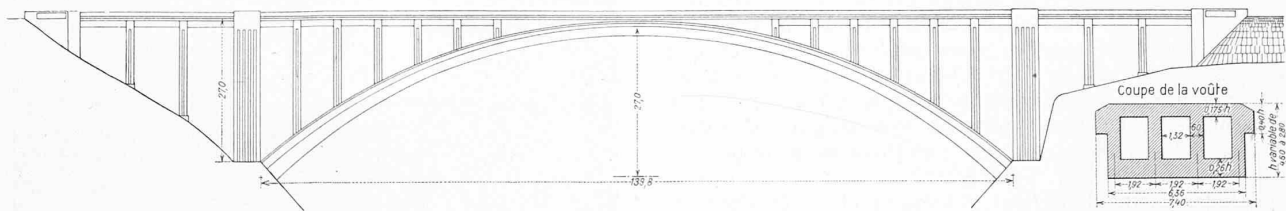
Elévation du nouveau Pont de la Caille avec arc en béton, portée 140 m. — Echelle 1 : 1250. — Coupe de la voûte 1 : 300.
